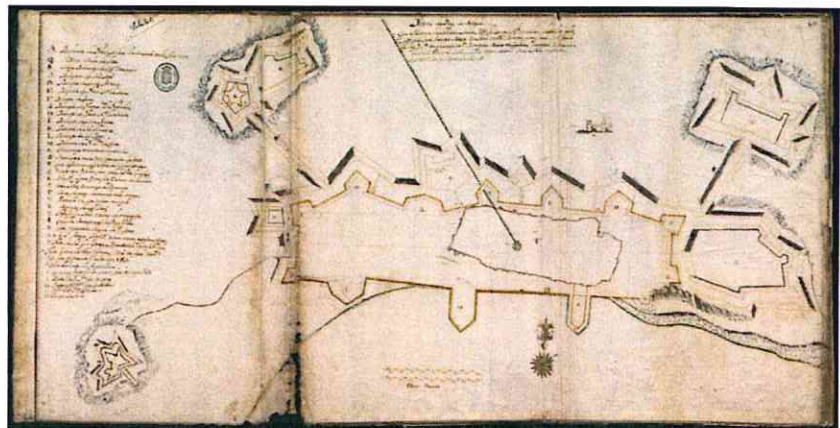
"LIVRO DE VÁRIAS PLANTAS DESTE REINO E DE CASTELA | por João Thomas Correa" (Setúbal). Cópia da planta desenhada por João Roiz Mouro em 1680. Biblioteca Nacional de Portugal
